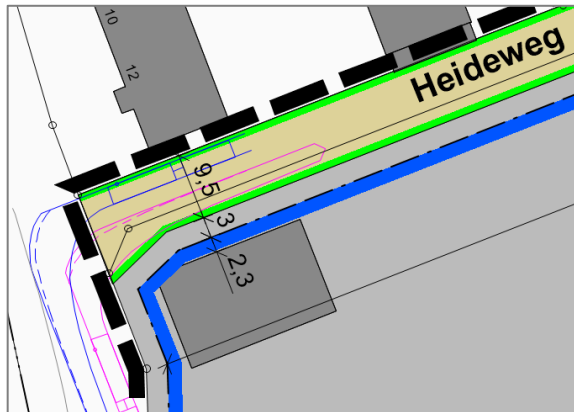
Einmündung Heideweg/Bahnhofstraße
